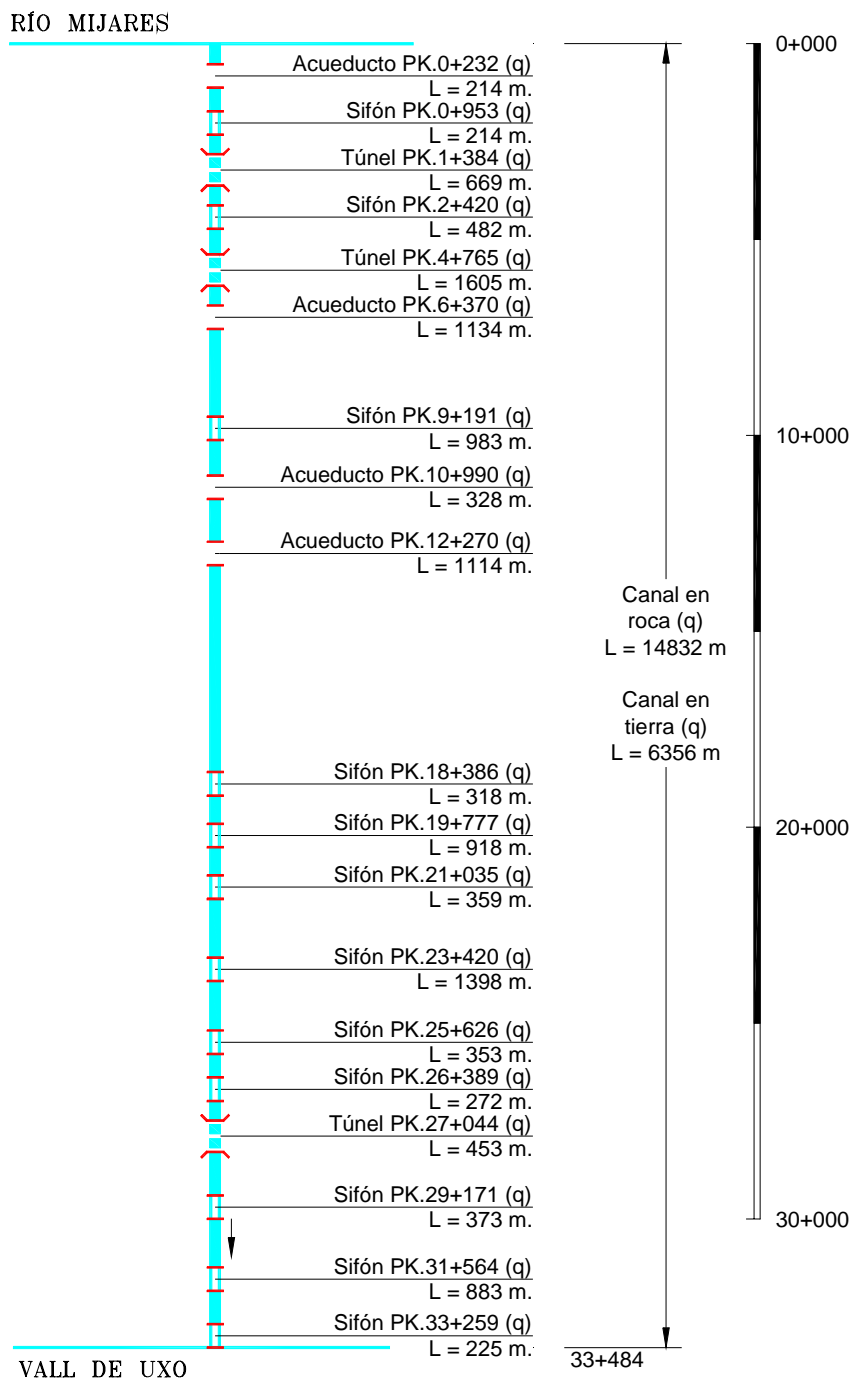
Conducción Mijares - Castellón Sur. Esquema en planta
